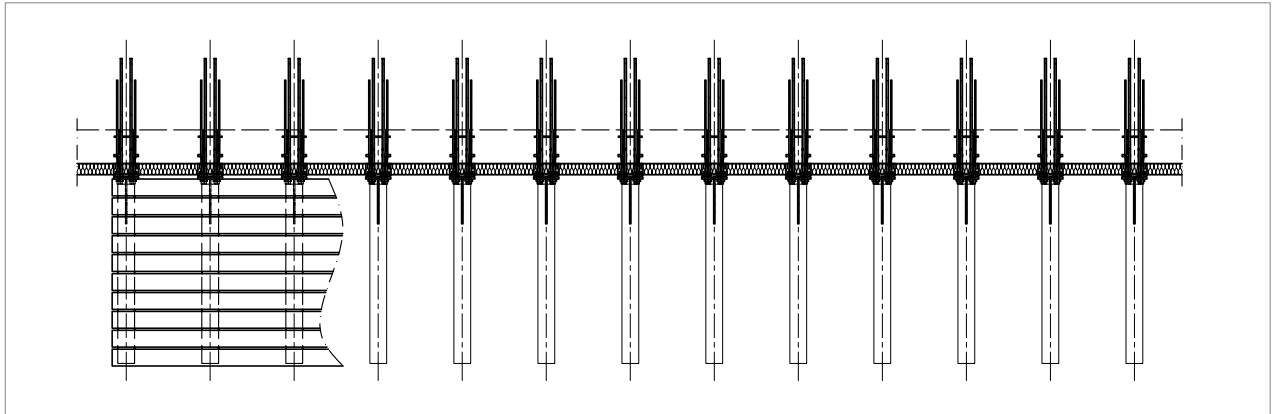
Schöck Isokorb® T type SK : balcon en porte-à-faux
